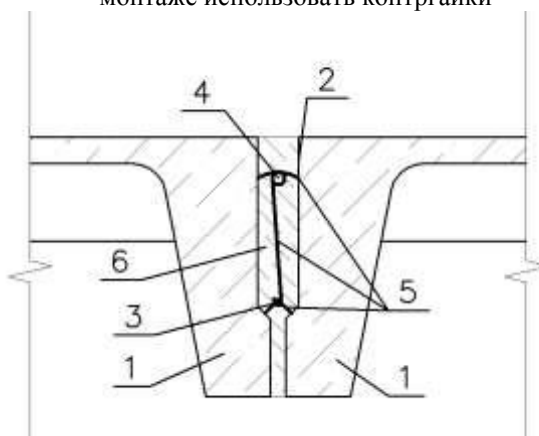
Установка дополнительной арматуры в швах между продольными ребрами плит
